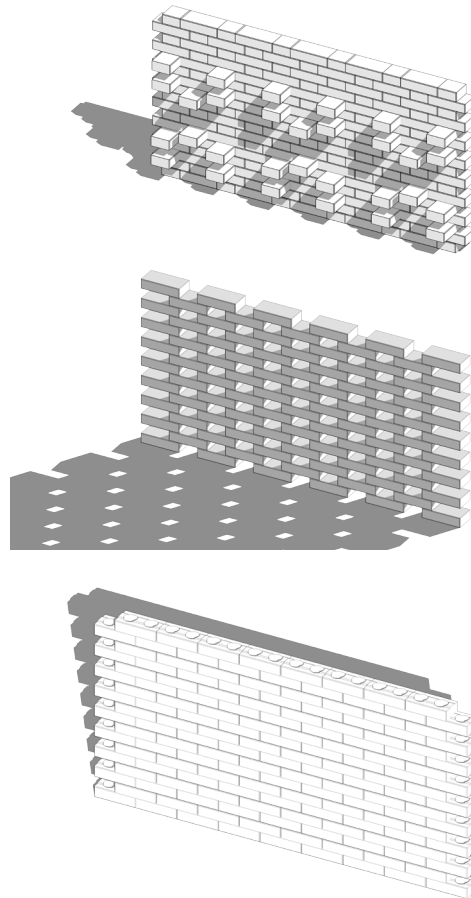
Aparelhamento de tijolos utilizados no projeto. Fonte: Produção própria
